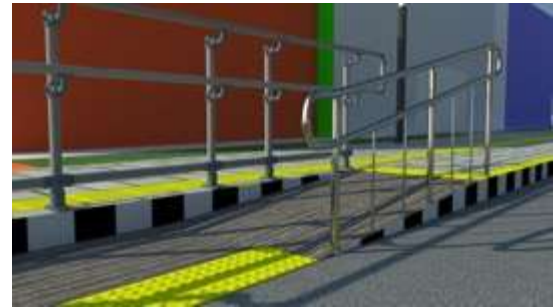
Denah Ramp untuk penyebrangan pejalan kaki
